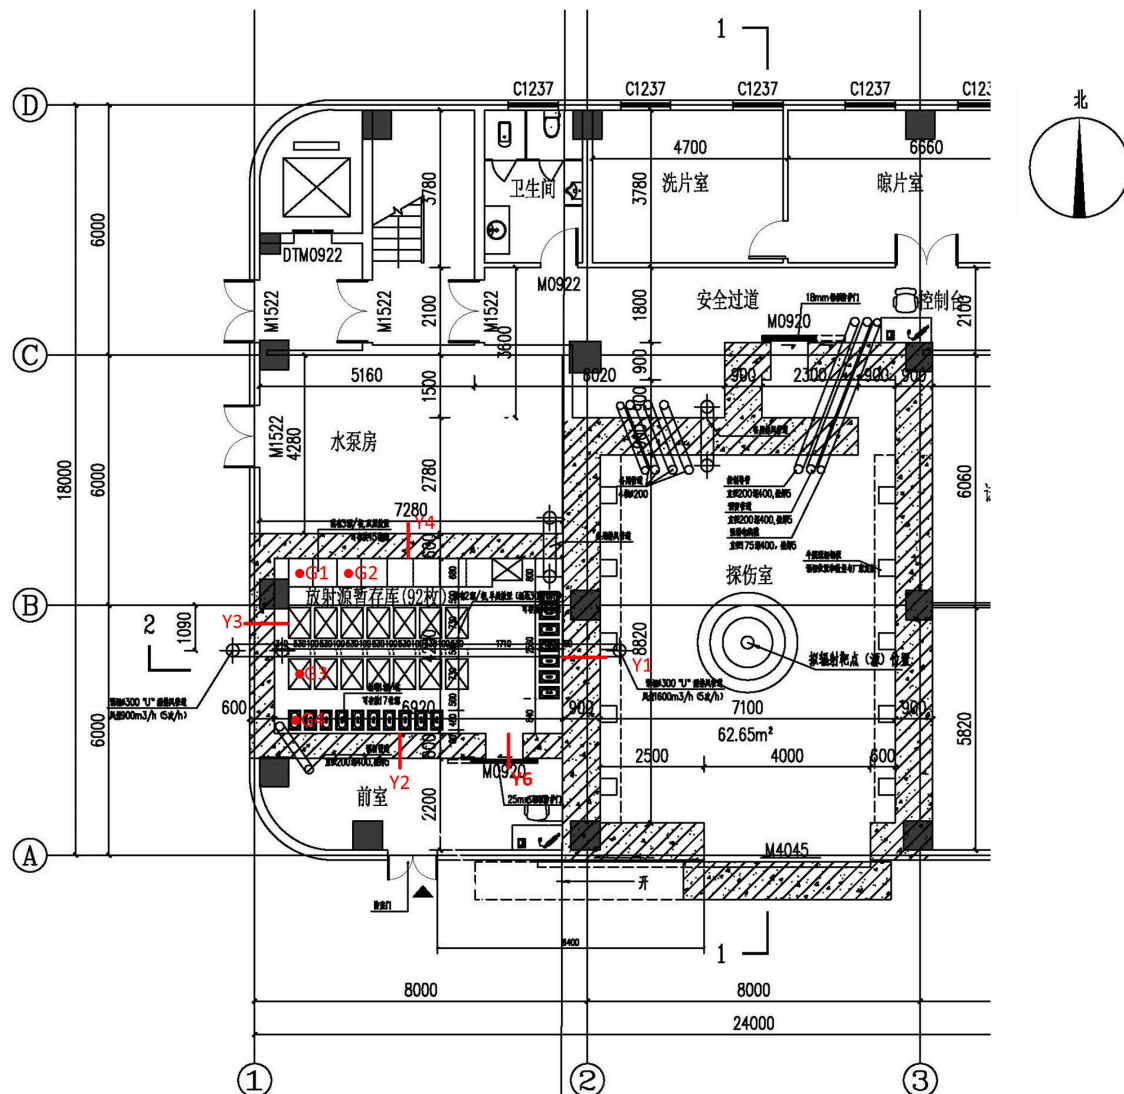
放射源库平面布局及关注点位示意图 (单位: mm)
